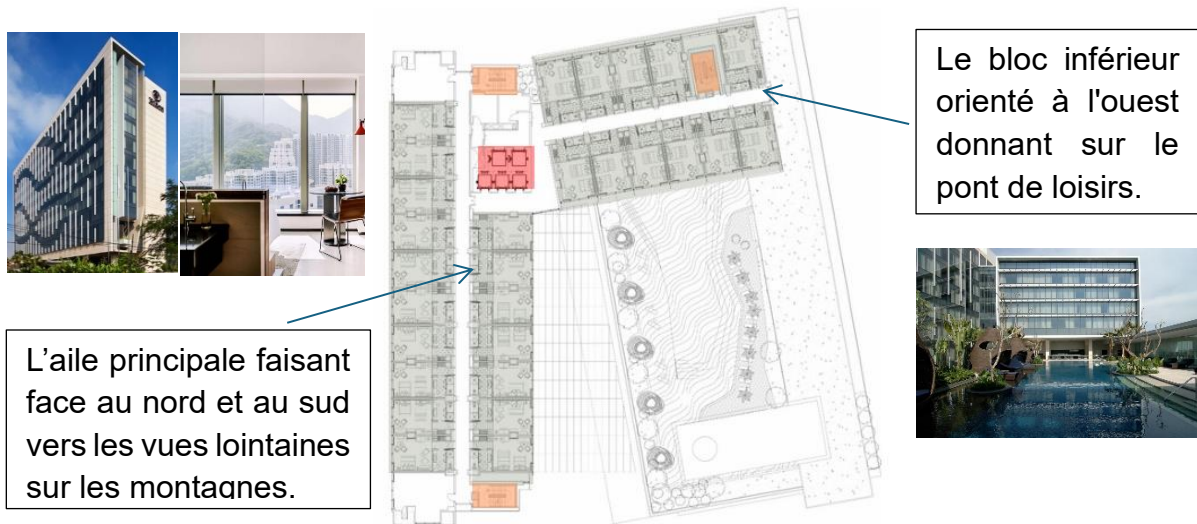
Plan des chambres et photos (Source : <https://www.archdaily.com>)
